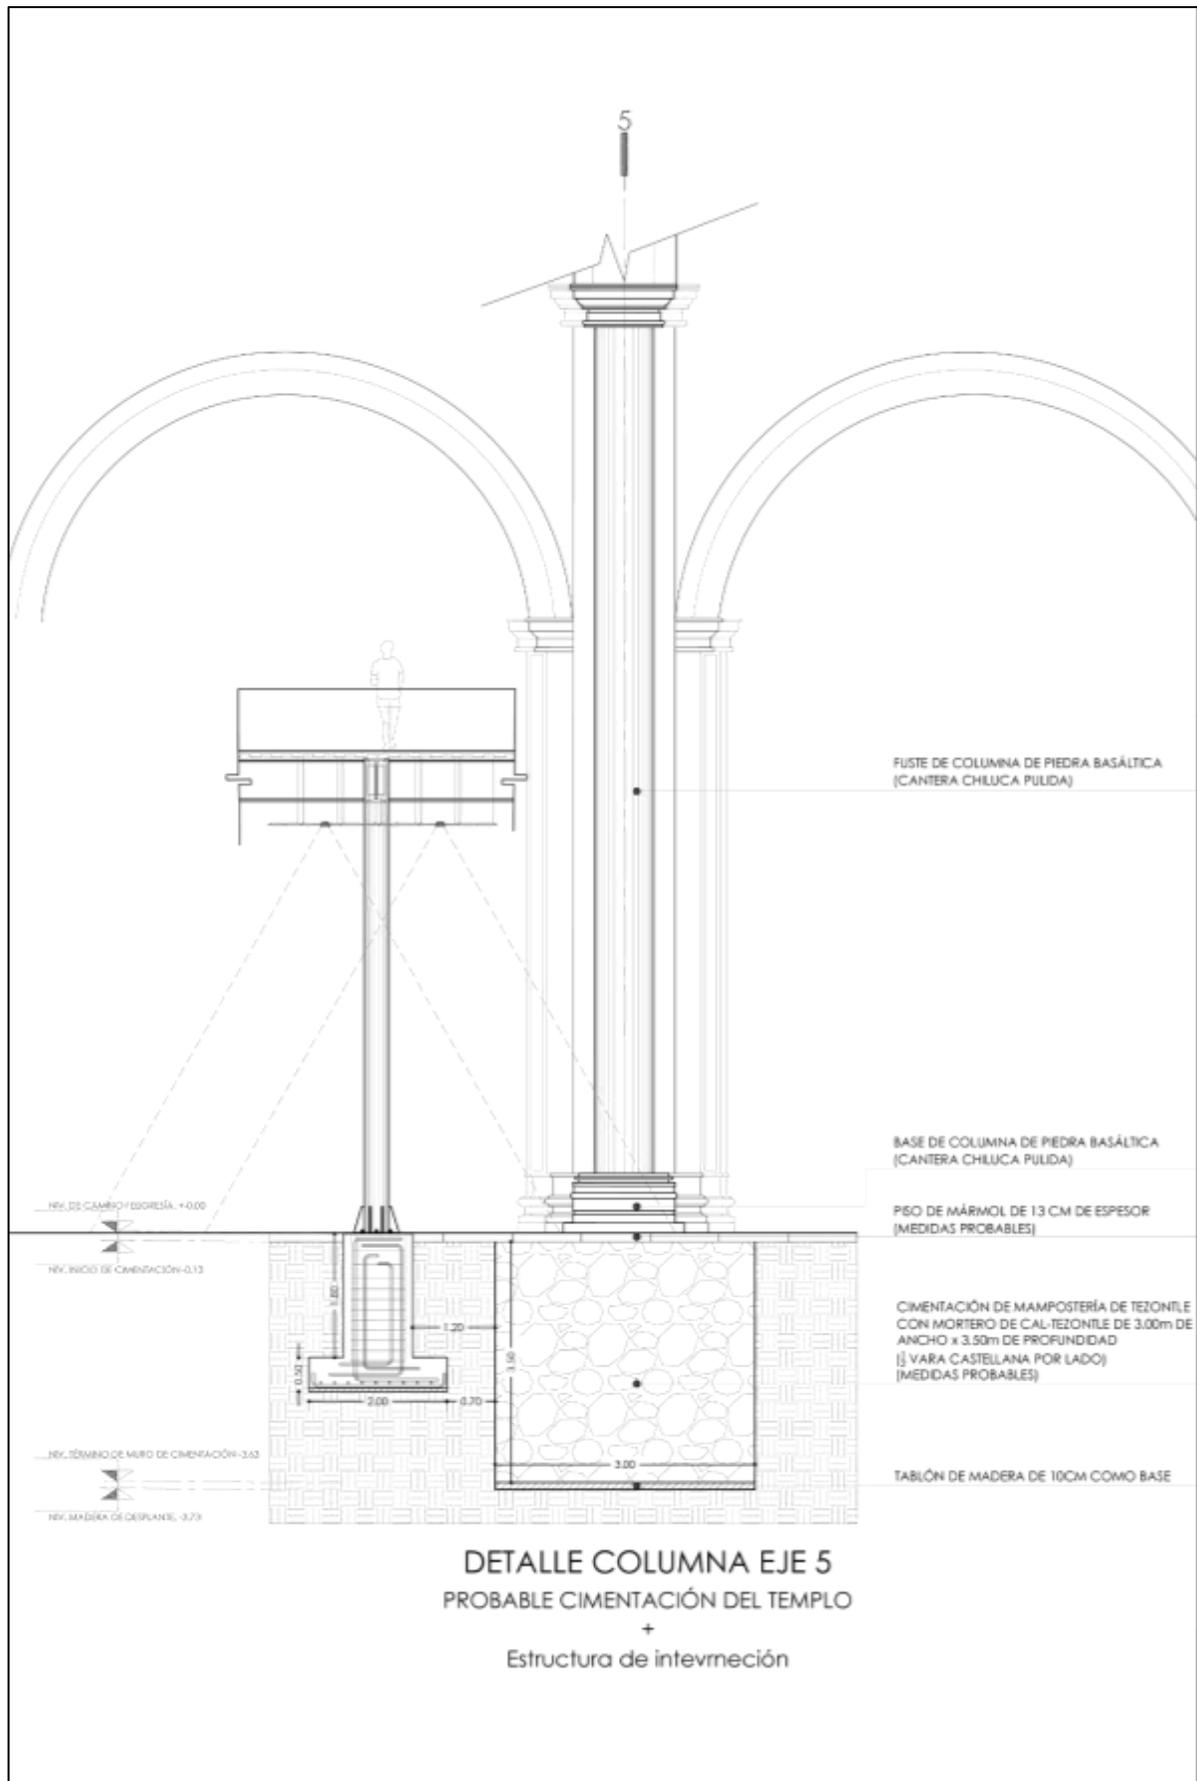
Alzado a detalle de la columna localizada en el eje 5 con cimentación a base de muros perimetrales y contrarabes de mampostería así como la propuesta de estructura al interior de la nave.
